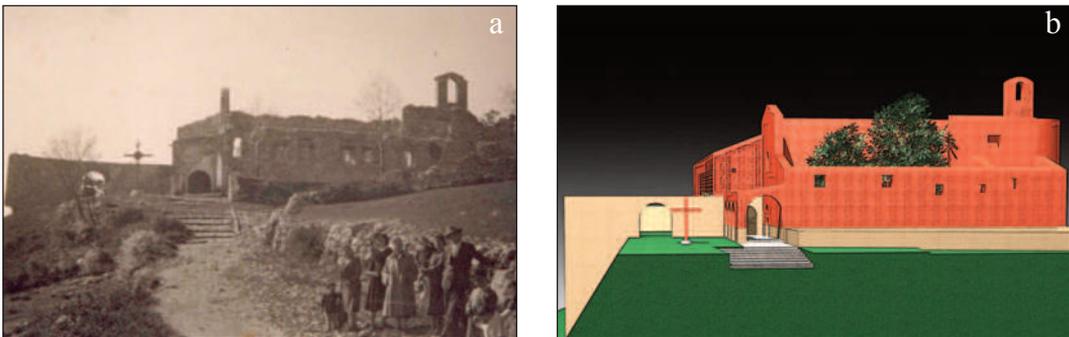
Vista del convento arrivando da Fiamignano: a) in una foto degli anni '40 del Novecento (archivio S. Adriani); b) nell’assetto finale previsto dal progetto preliminare (Più Studi Architettura, 2010)
